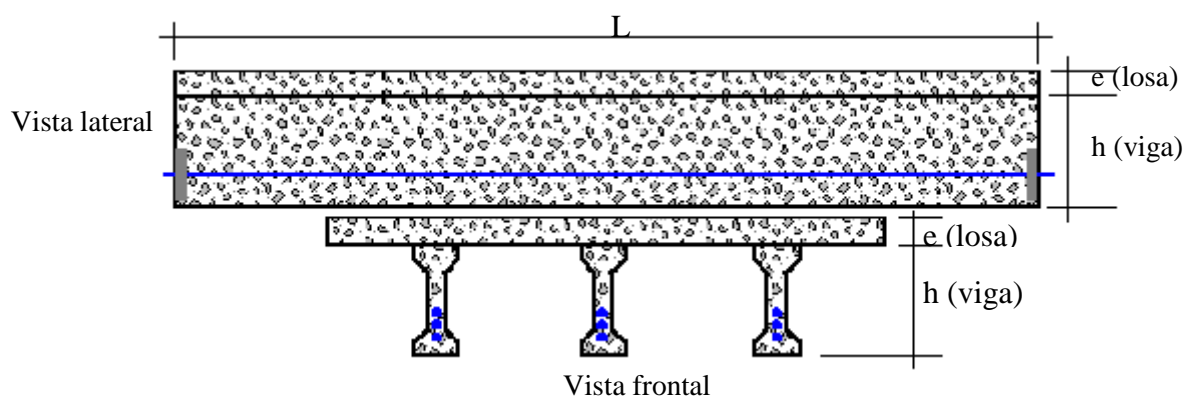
Puente con Vigas de Concreto Pretensado.
